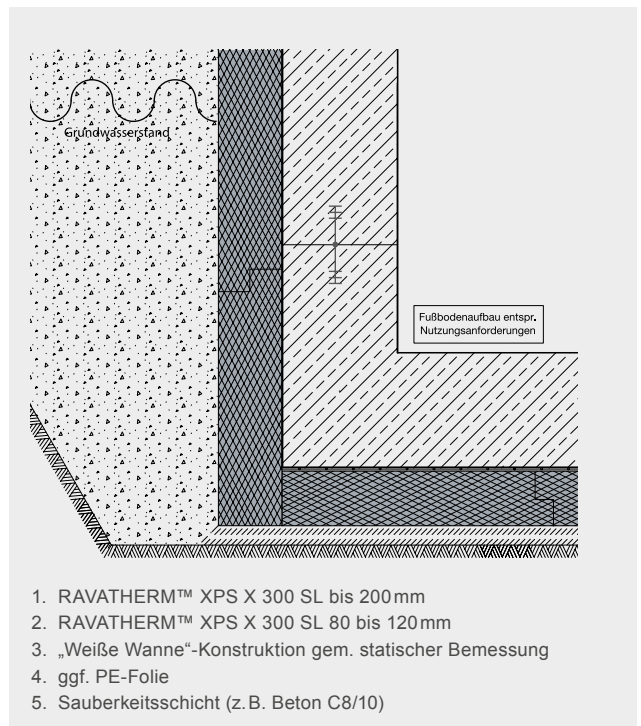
Detailbeispiel Fußpunkt „Weiße Wanne“: Wärmedämmung an Wand und unter lastabtragender Gründungsplatte in drückendem Wasser
